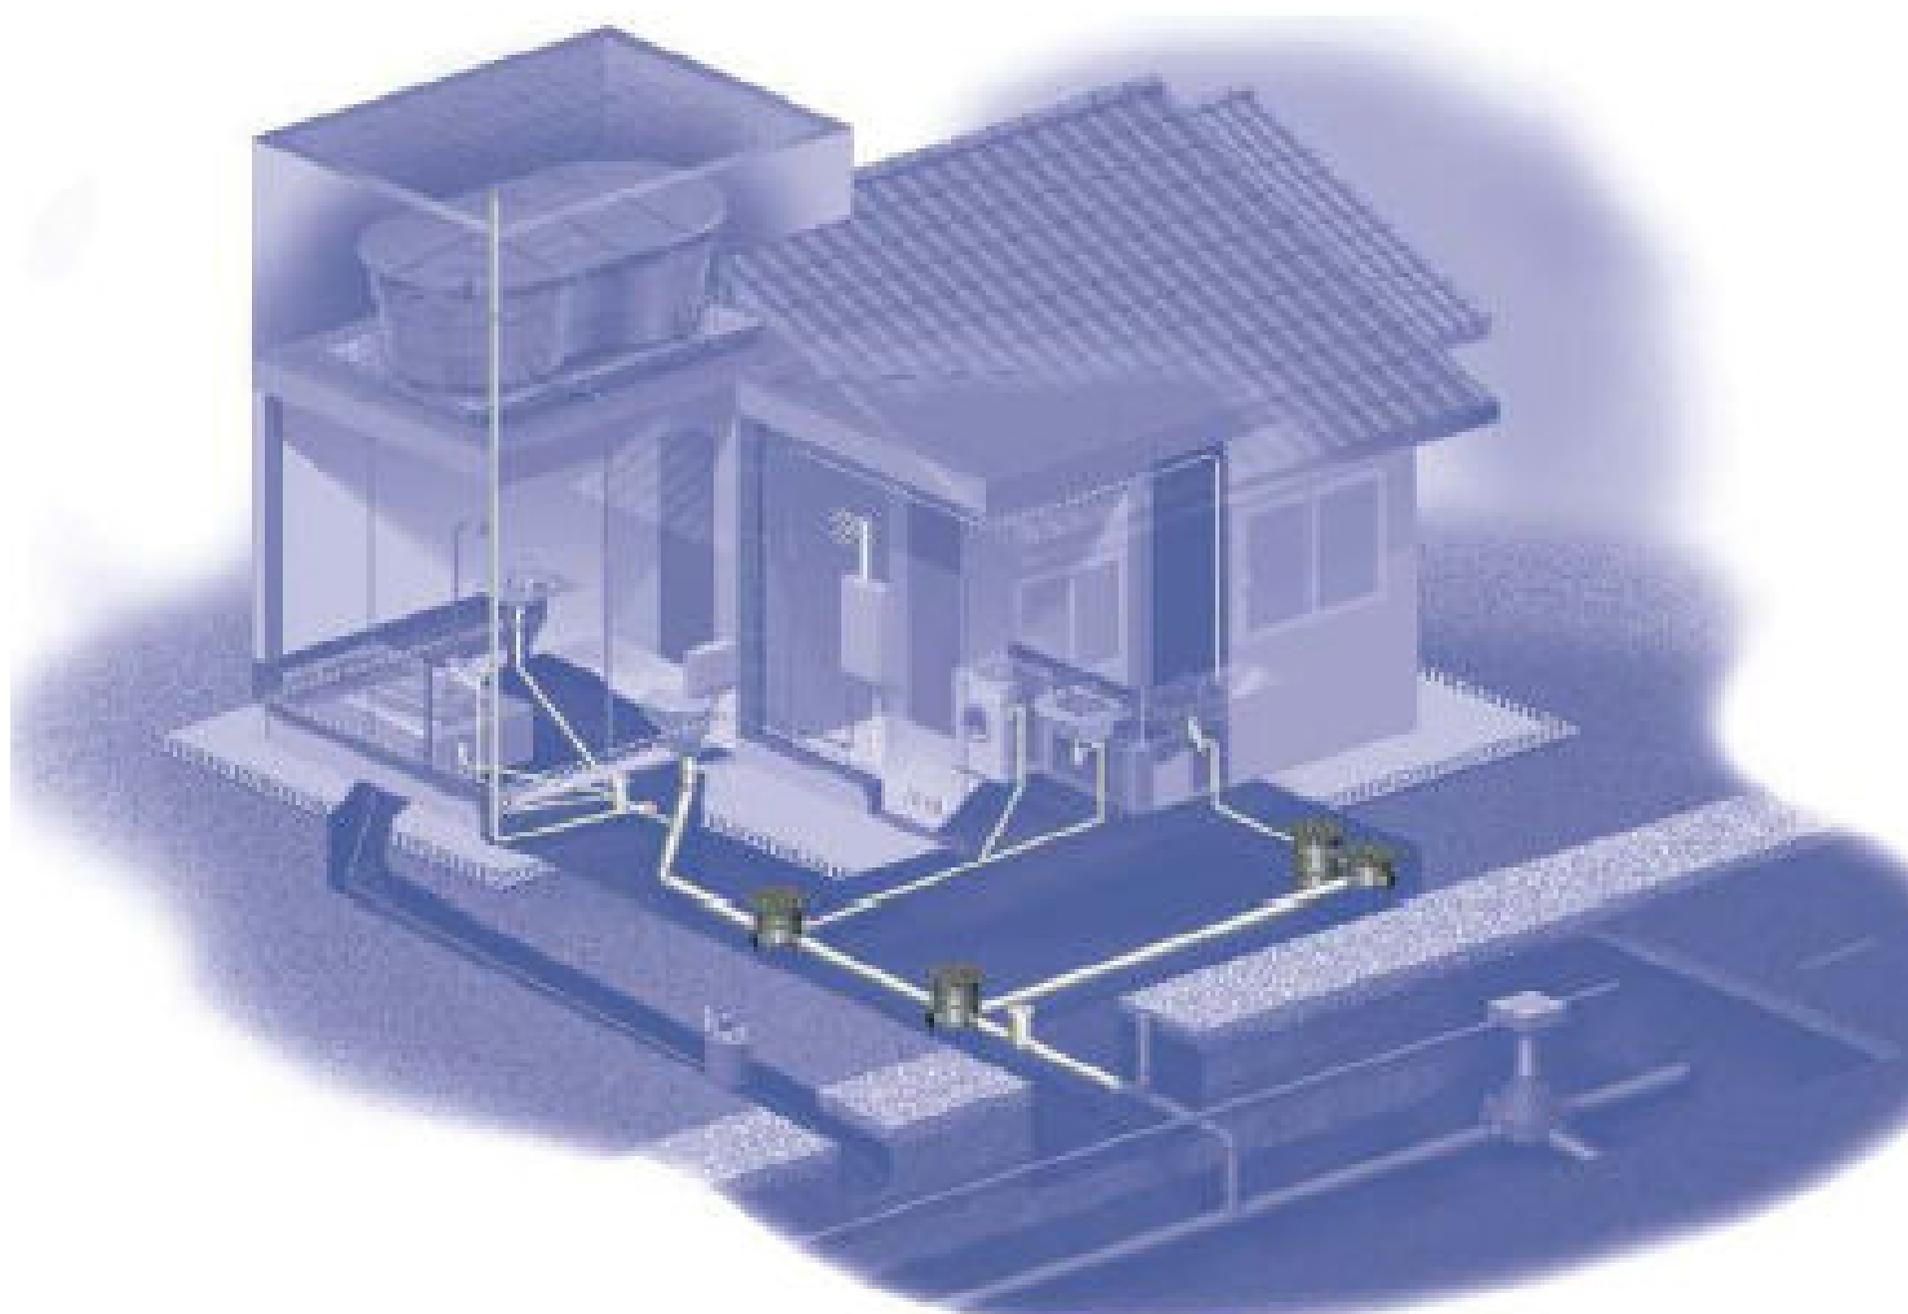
Vista geral da distribuição de um sistema esgoto sanitário
